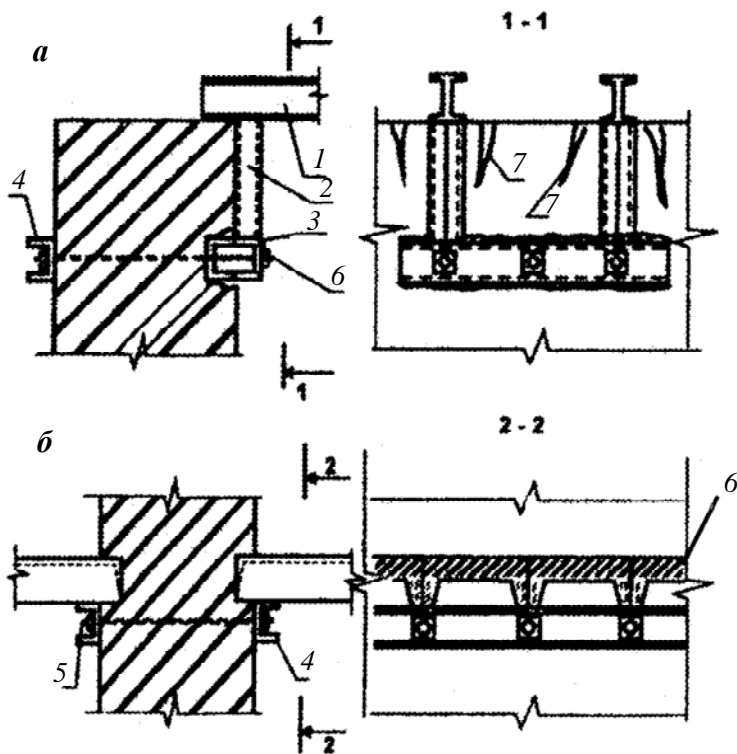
Увеличение площади опирания балок и плит на кирпичную стену:
